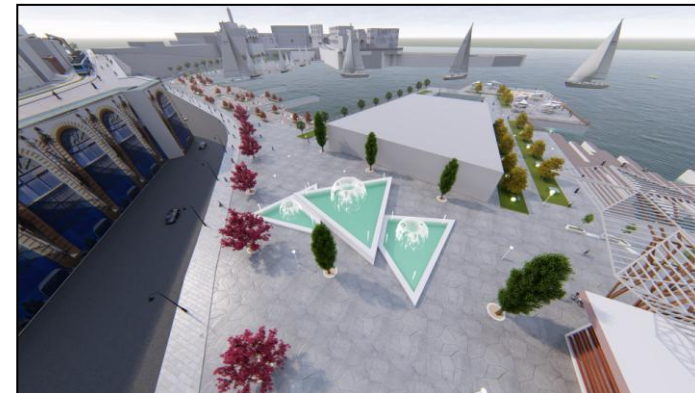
Vue d'ensemble sur le boulevard du front de mer
